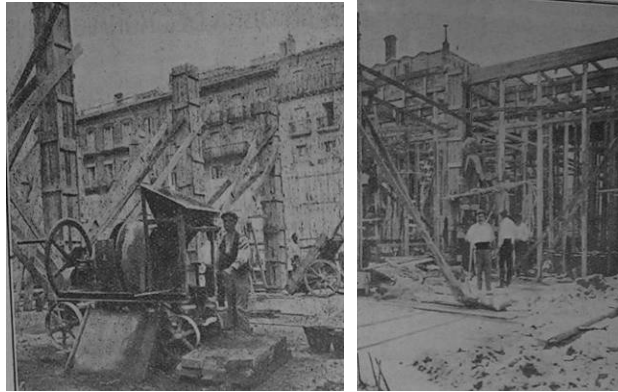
Encofrados de una casa en construcción en San Sebastián. (Gallego, 1918).
